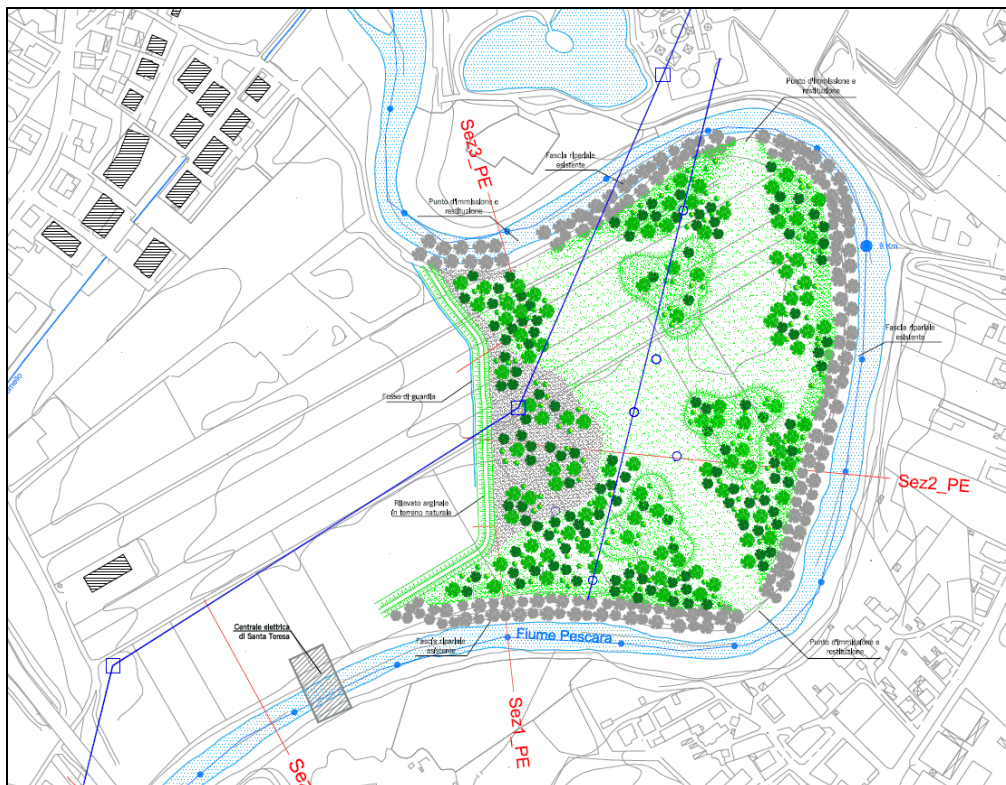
Stralcio della planimetria di progetto della cassa di espansione presso S.Teresa di Spoltore.
